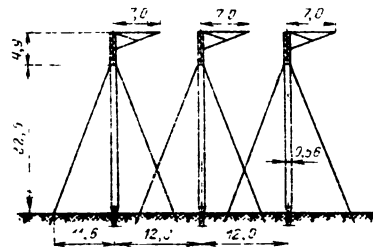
Железобетонные анкерные угловые опоры на оттяжках (одной цепи ВЛ 500 кВ)
